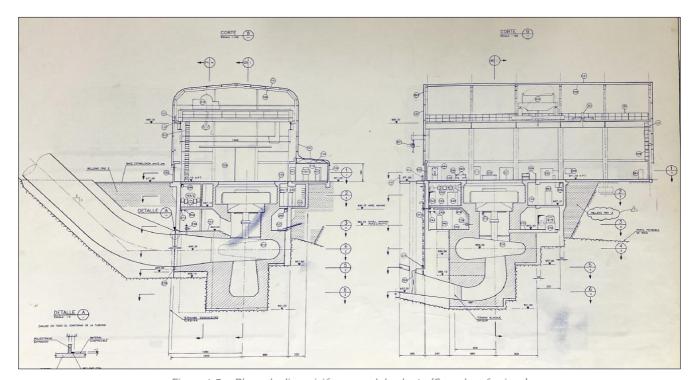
Plano de disposición general de planta (Casa de máquinas)
